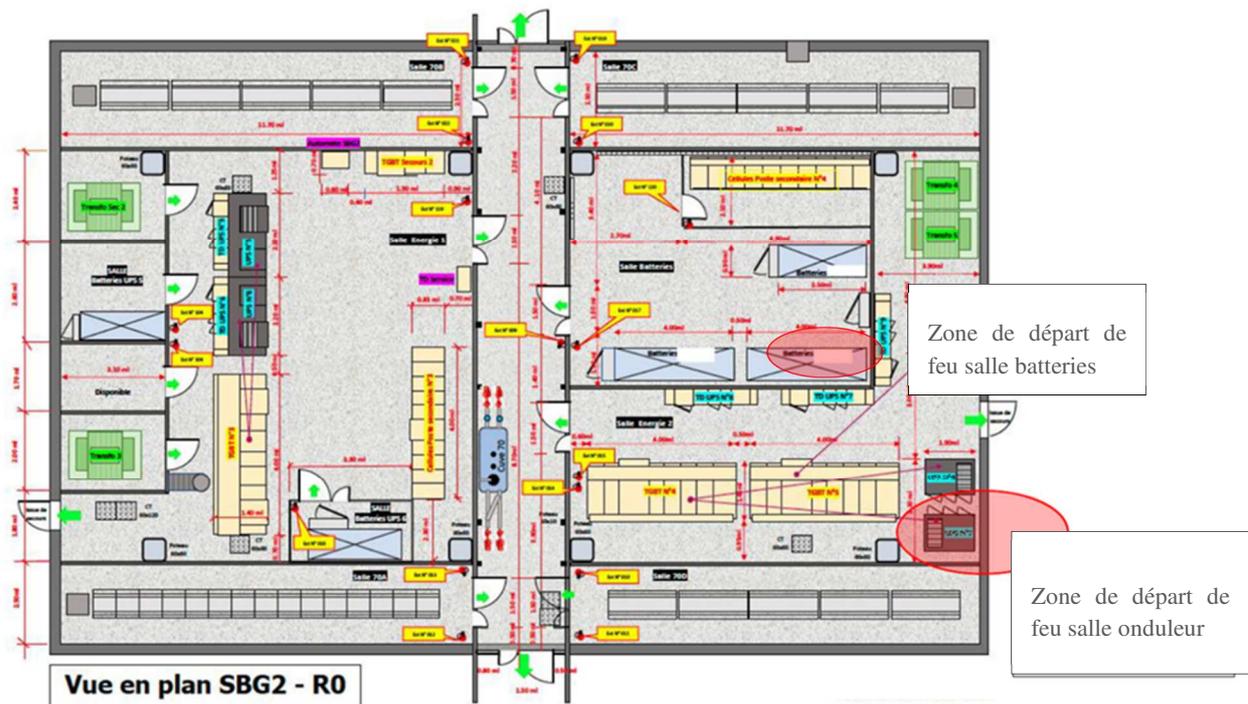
Plan du R0 du bâtiment SBG2 (plan source OVH). La zone de départ incendie a été ajoutée par le BEA-RI dans le but d'améliorer la lisibilité du plan et la compréhension du texte. (Le même plan a une échelle plus grande figure en annexe 3)
